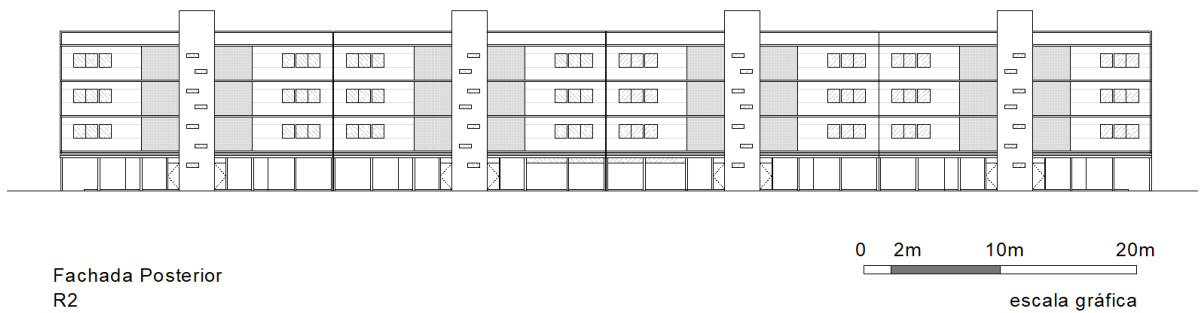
Fachada posterior do R2. Fonte: da autora, adaptado das pranchas originais Acervo do Arquiteto Milton Ramos.
